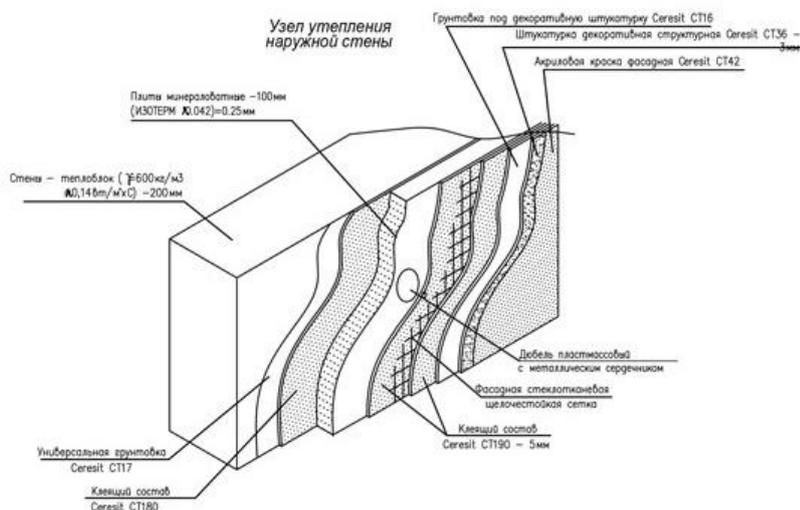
Узел утепления наружных стен по системе Ceresit
